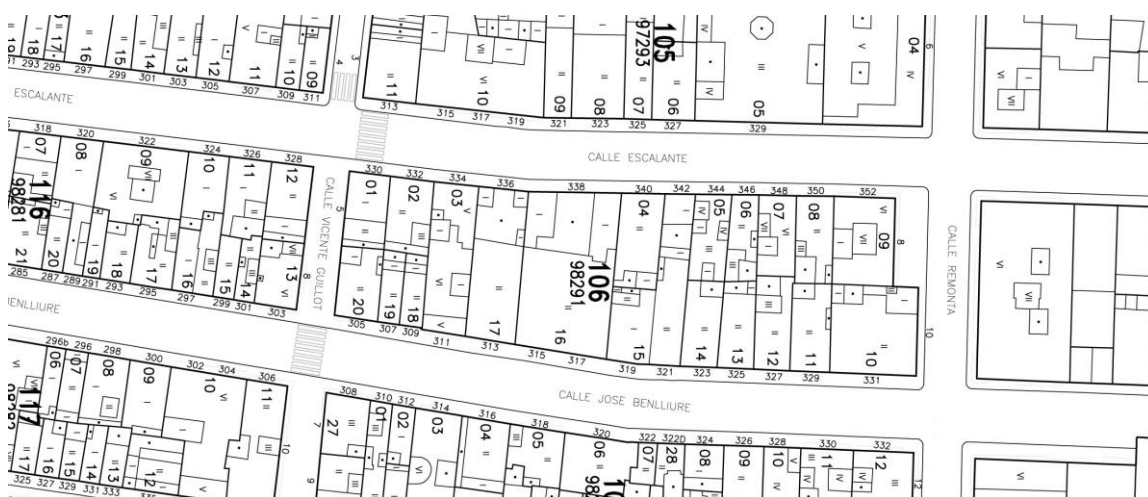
2. Plano situación Alzado tramo calle José Benlliure y plano de situación. (Ord. PEPR I. Cabanyal-Canyamelar. T 1, 17)
